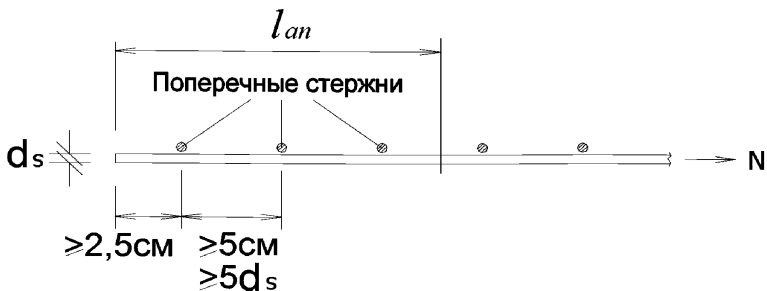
Анкеровка сварной сетки (l_{an} – длина зоны анкеровки)
